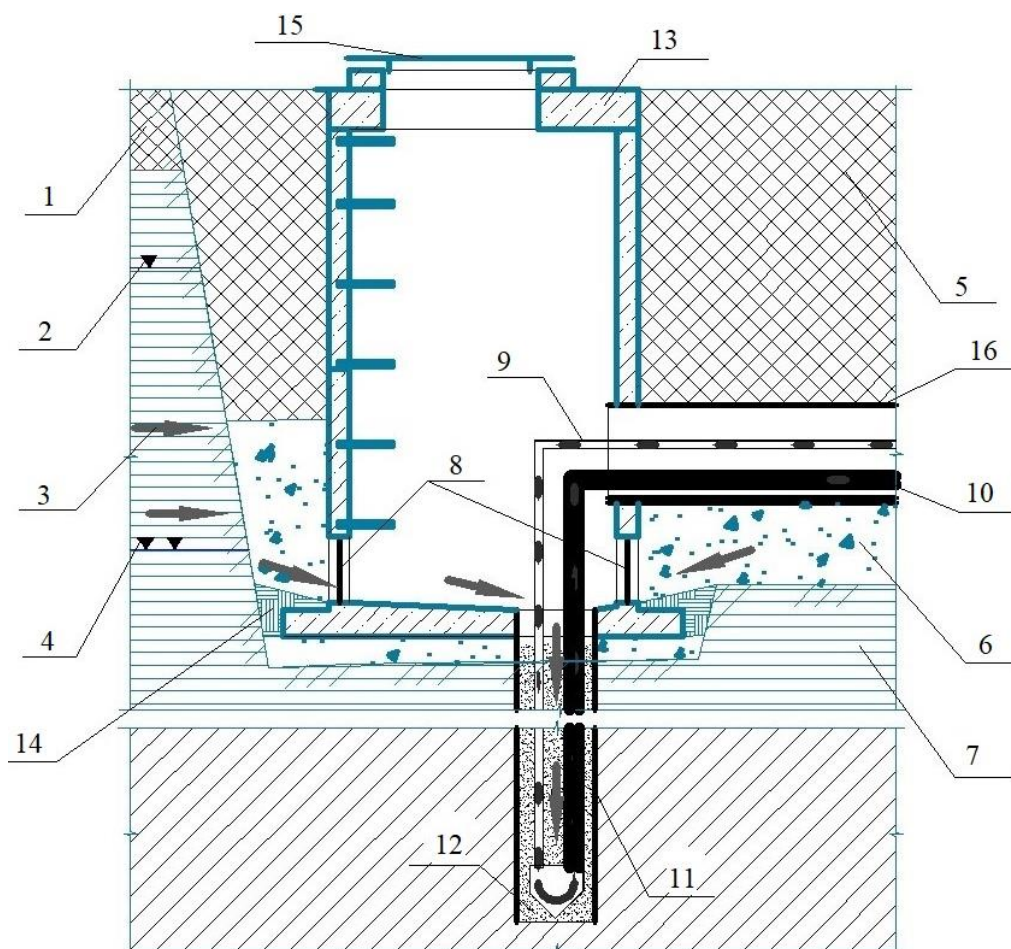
Схема геотермального устройства для водоупорных грунтов: 1 – грунт; 2 – отметка сезонного уровня поверхностных вод; 3 – грунтовые и осадочные воды; 4 – отметка установившегося уровня поверхностных вод; 5 – насыпной грунт; 6 – щебень фракции 5-40 мм; 7 – водоупорный грунт; 8 – фильтр грубой очистки; 9 – подающая труба; 10 – обратная труба; 11 – буровая скважина в обсадной трубе; 12 – заполнителя зонда; 13 – железобетонная камера; 14 – водоупорный грунт; 15 – крышка камеры; 16 – железобетонный лоток.
